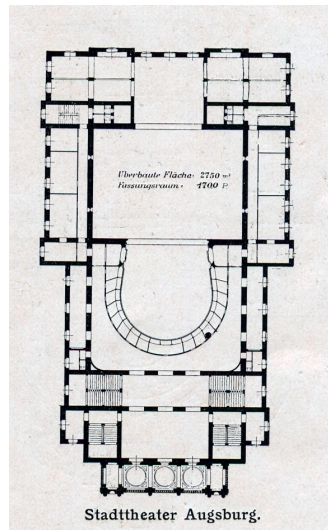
Theater von Augsburg, Grundriss Erdgeschoß
